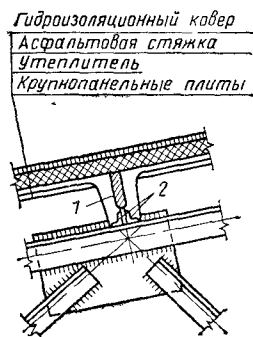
Узел кровли по крупнопанельным плитам
